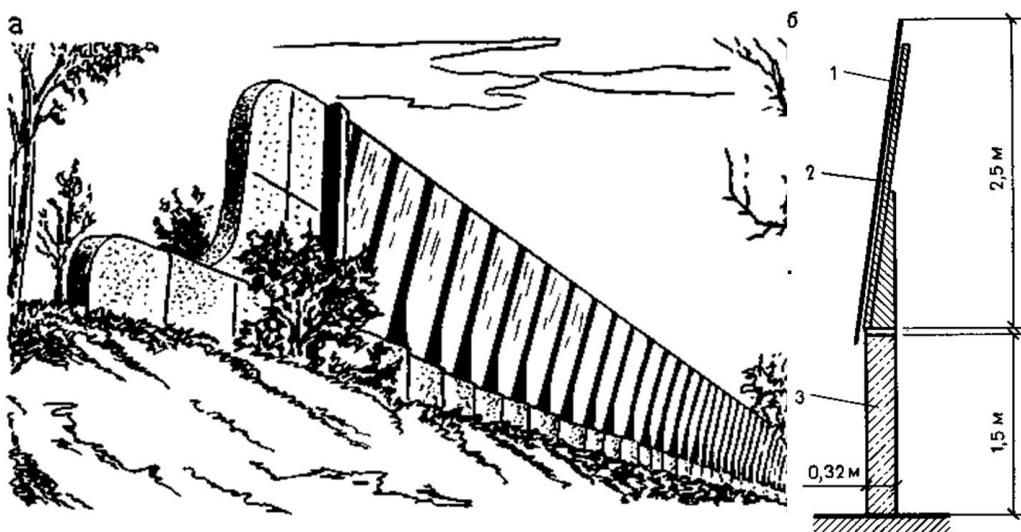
Проект будівельно-акустичного екрану по вул. Хмельницьке шосе, 98 (м. Вінниця): а – загальний вигляд; б – конструктивна схема: 1 – ущільнене скло; 2 – металевий каркас; 3 – бетонна стінка.
